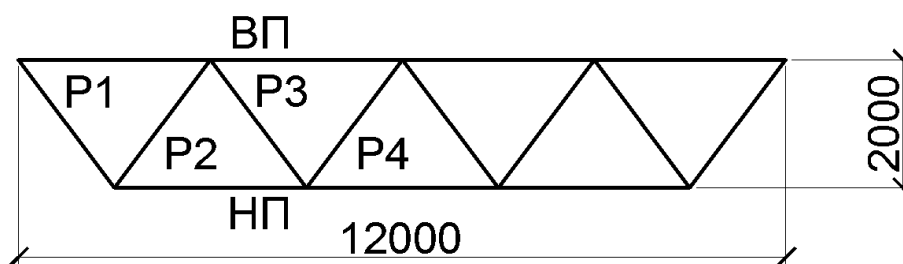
Обозначение стержней подстропильной фермы ПФ6
